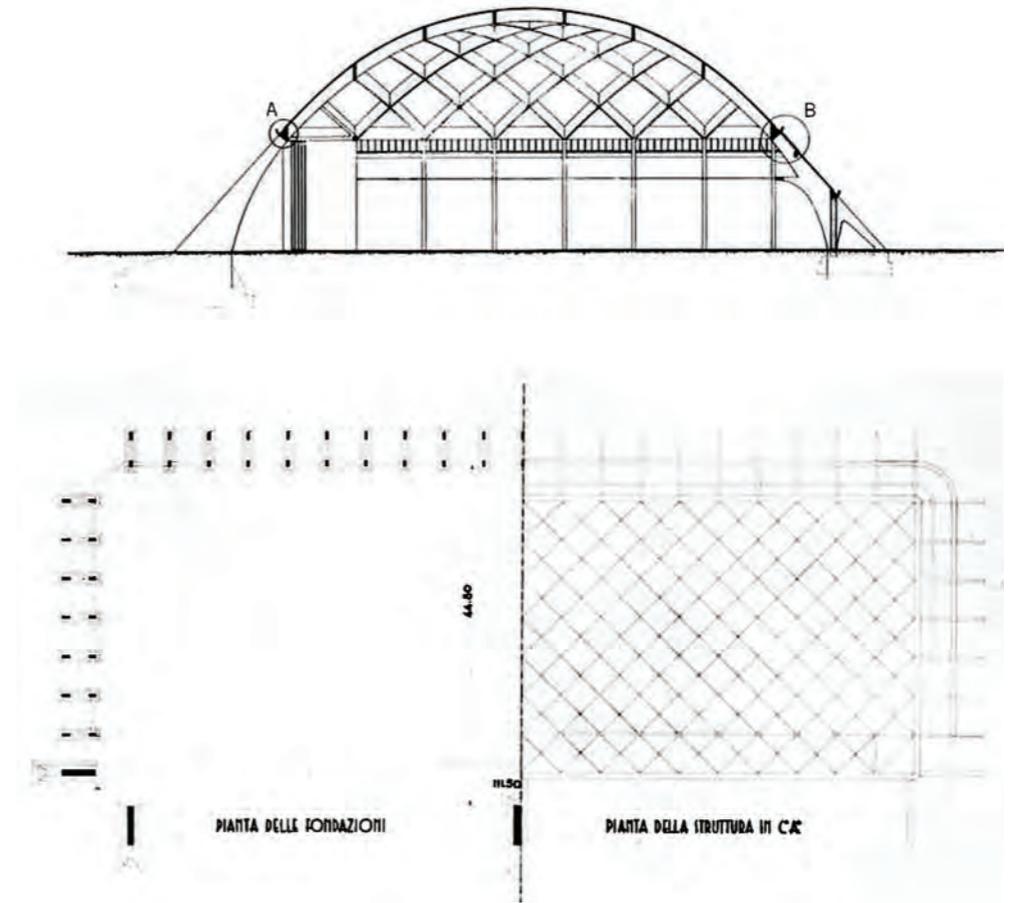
Querschnitt und Grundriss des Flugzeughangar in Orvieto. Im Grundriss sind links die Fundamente erkennbar und rechts die Rippen, welche so plaziert sind, dass sie im Grundriss ein quadratisches Raster ergeben.
